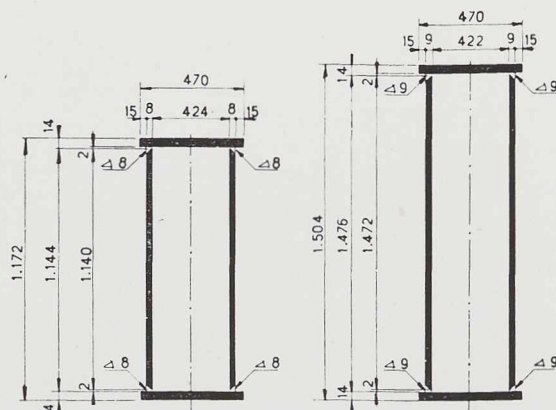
Sections en caisson des arcs du pont de Neuilly-sur-Seine.
